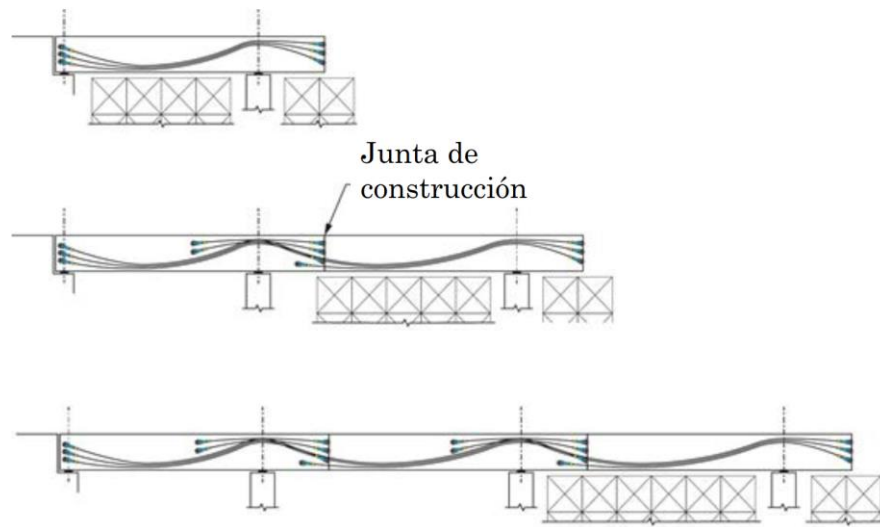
Trazado de cable postesado en vigas continuas construidas por tramos (Fuente: [12]).
